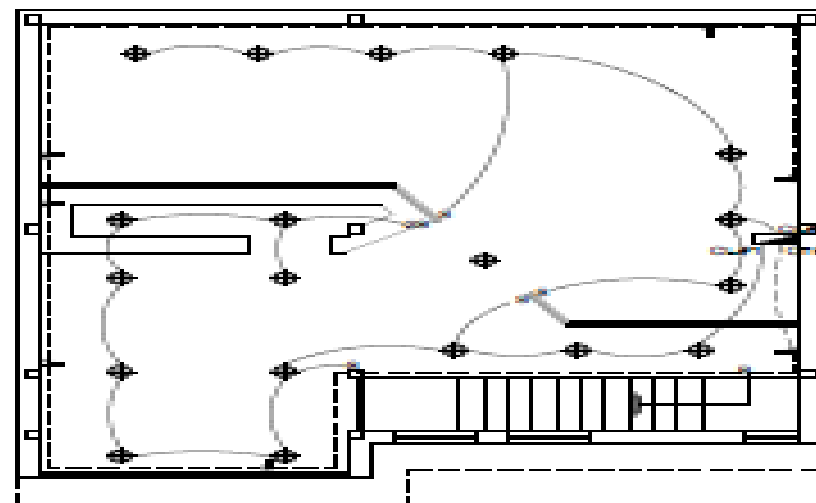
Planta tipo de las 3 salas de exposición del centro interpretativo
